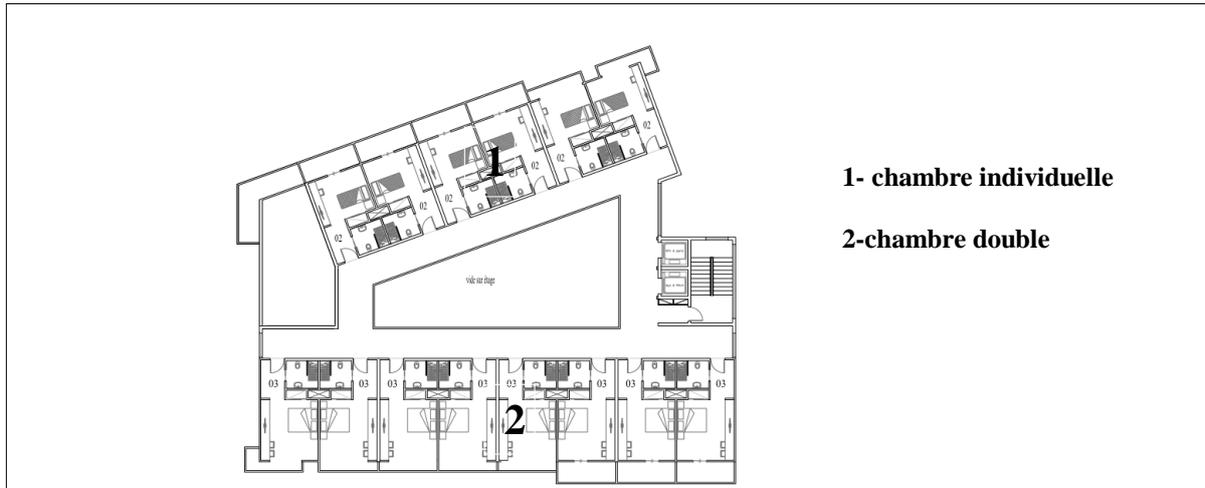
plan chambres type 02, (Source : auteur 2018)
